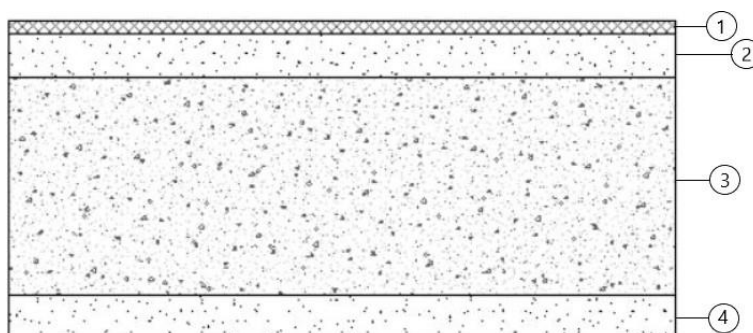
Pormenor da constituição do pavimento intermediário - salas de aula e circulação
